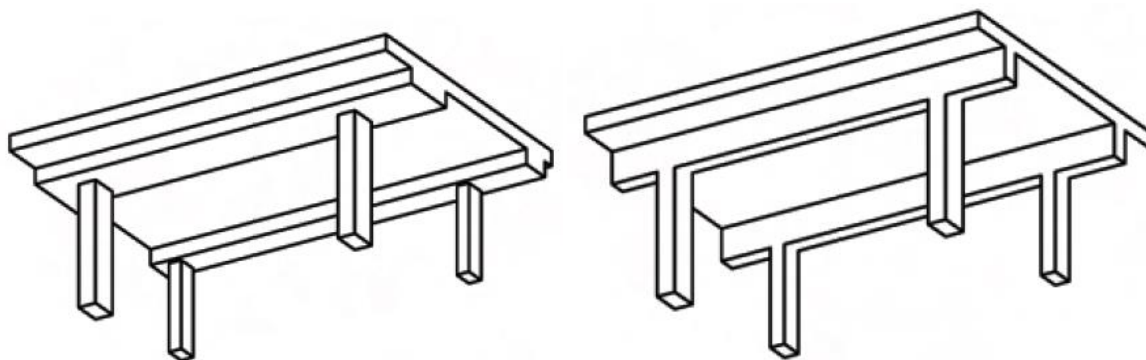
Lajes unidirecionais com vigas planas ou altas [B9]
